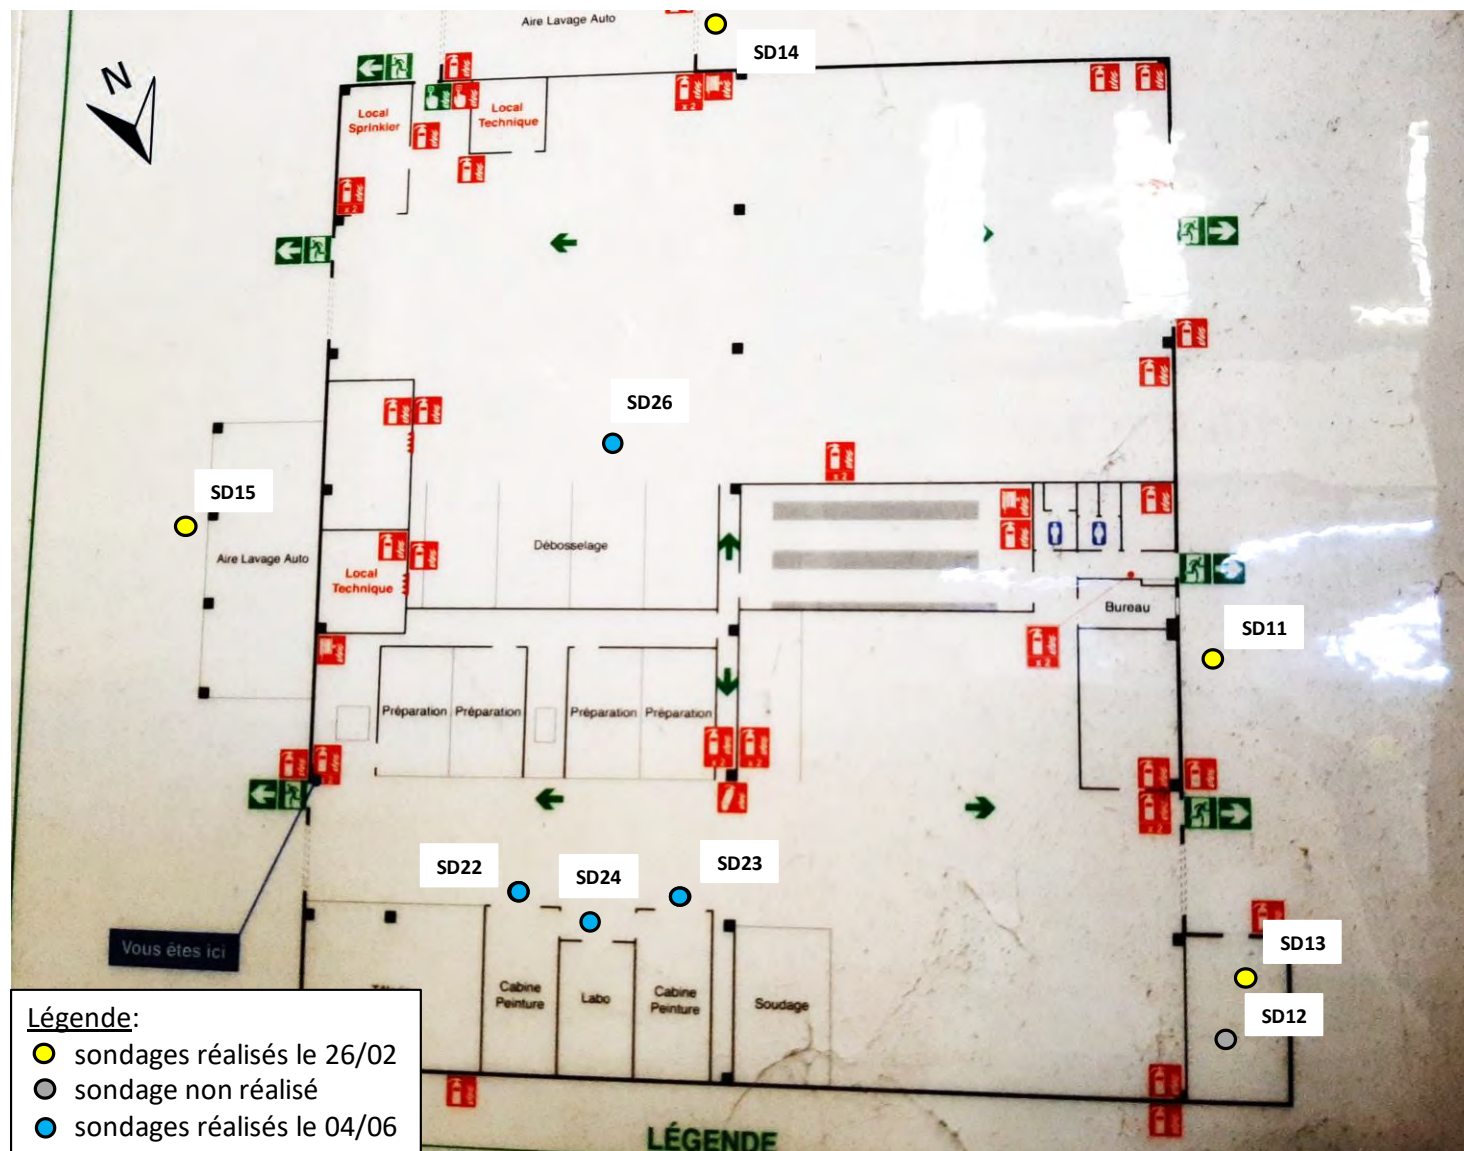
Sondages réalisés à l'intérieur et à proximité du bâtiment d'atelier de réparation (fond de plan : plan incendie))
